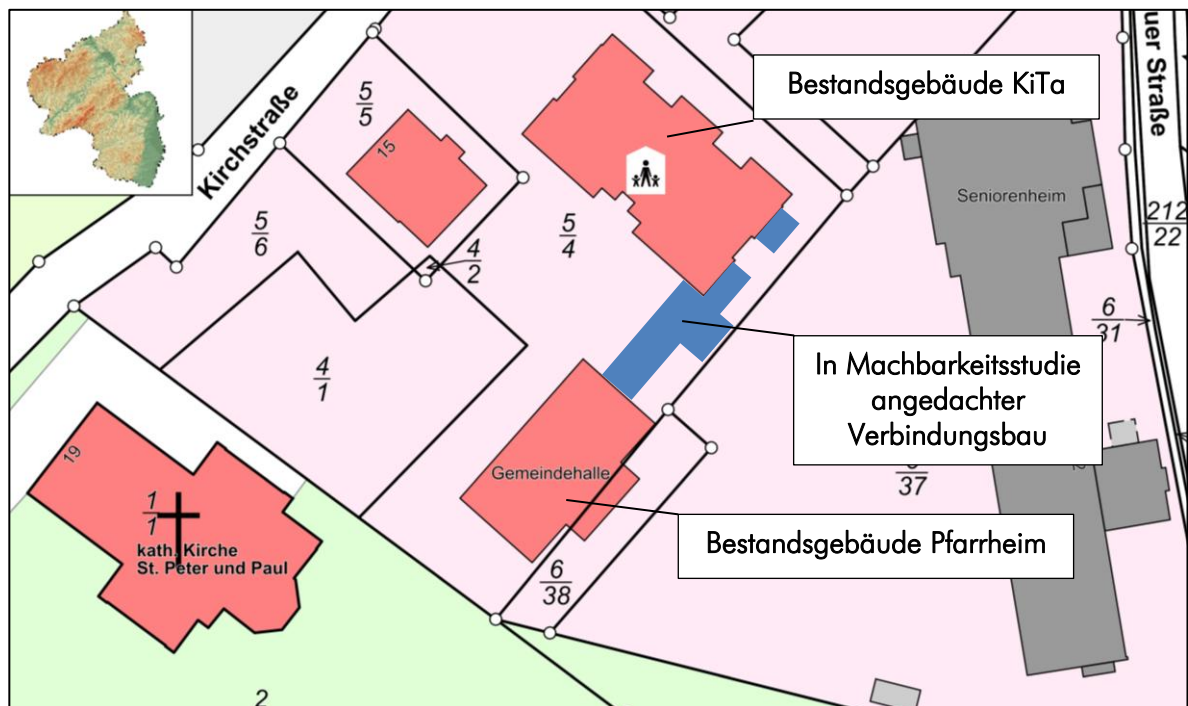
Lageplan mit Markierung der betrachteten Bestandsimmobilien und Darstellung des geplanten Verbindungsbaus
